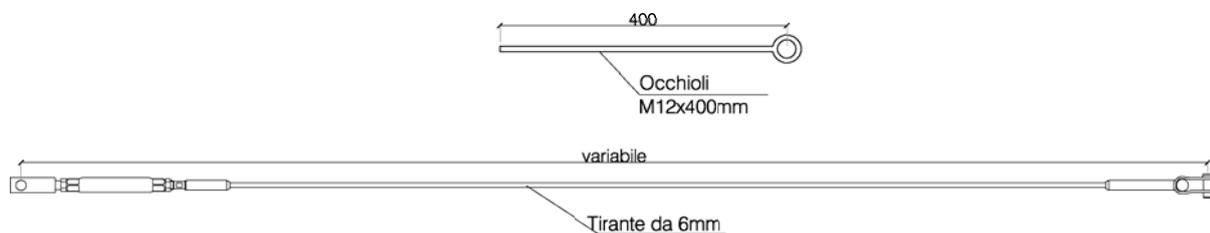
Collegamento della trave di coronamento al muro di banchina
